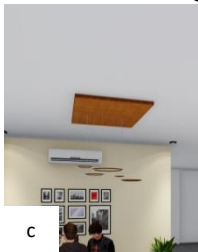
Drop Ceiling Persegi Panjang
